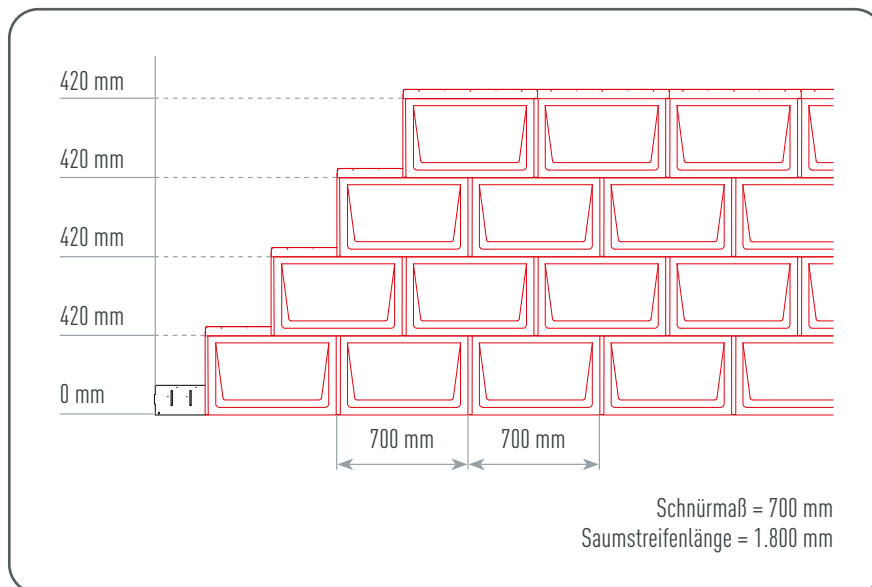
• Dachplatte R.16 – Schnürmaß
